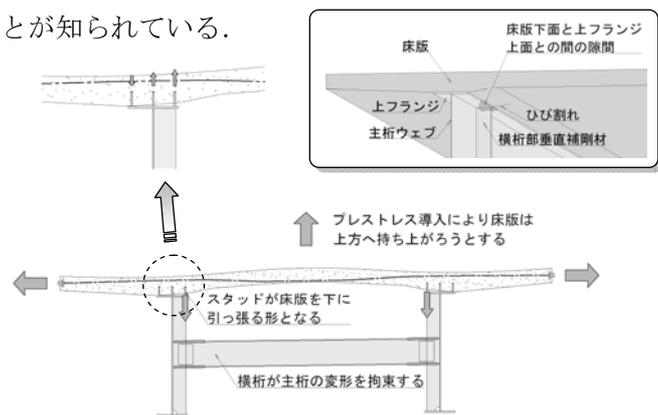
ひび割れ・肌すき発生の原因と状況
